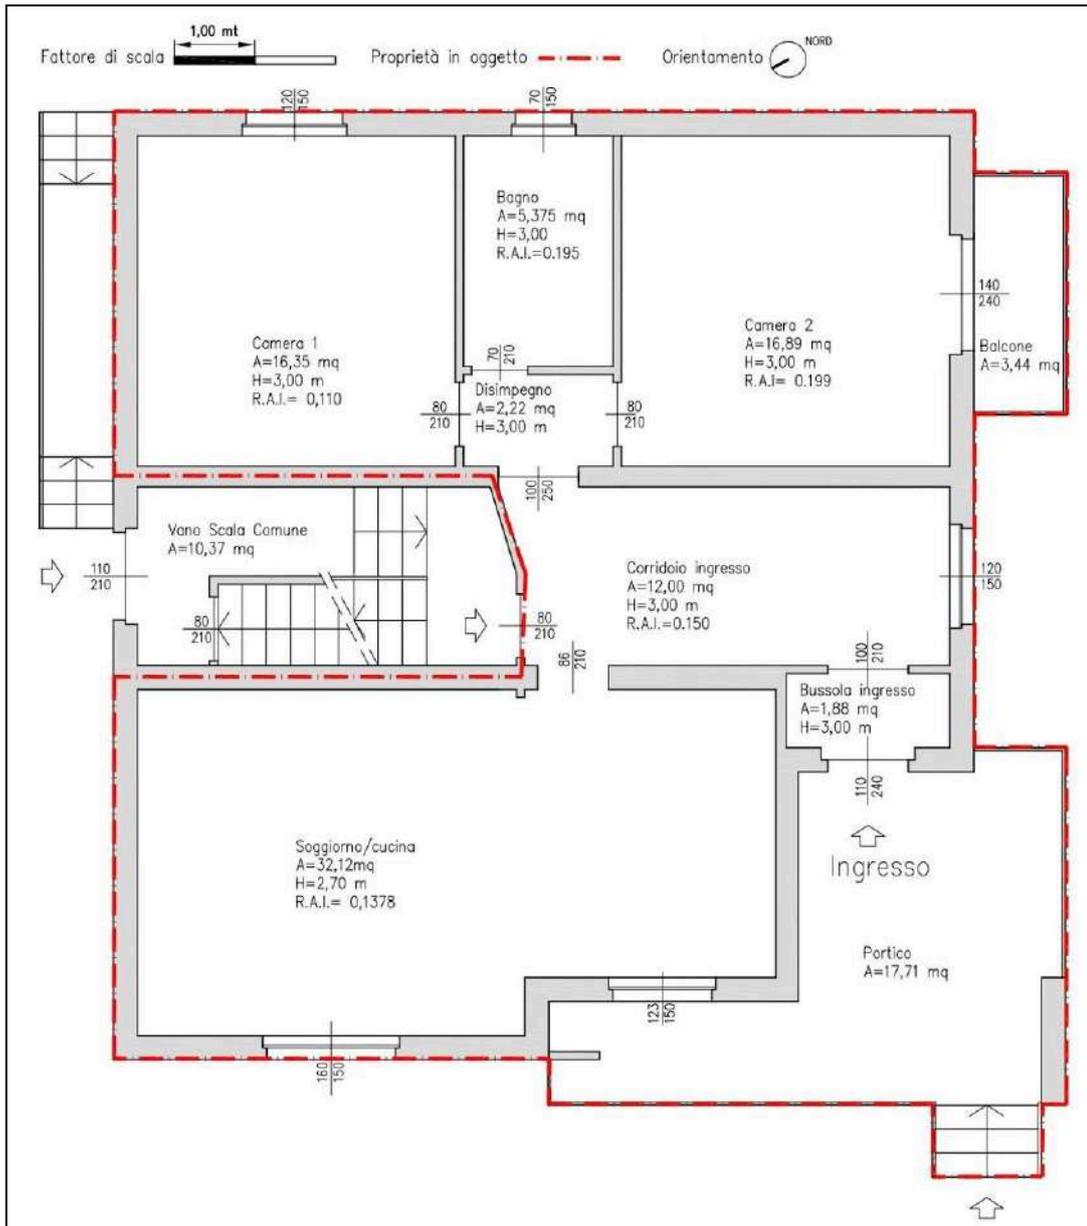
Pianta di rilievo dell'appartamento (piano rialzato)
